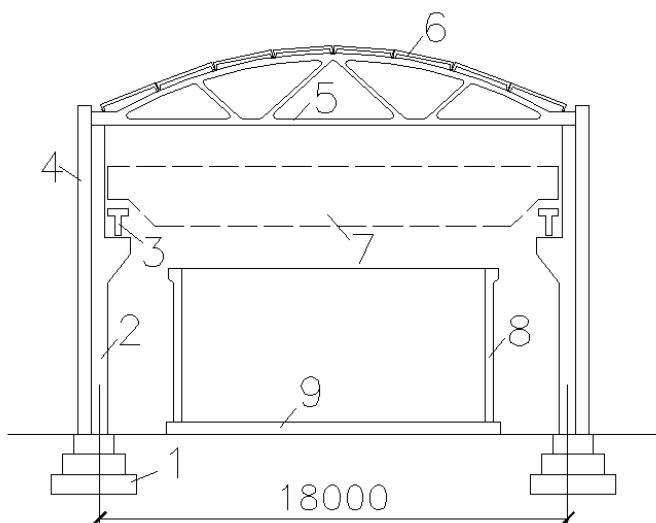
Поперечный разрез здания фильтров: 1 – фундамент; 2 – колонна крайнего ряда; 3 – подкрановая балка; 4 – стекловые панели; 5 – стропильная ферма; 6 – плита покрытия; 7 – мостовой кран; 8 – стекловые панели фильтра; 9 – днище фильтра
